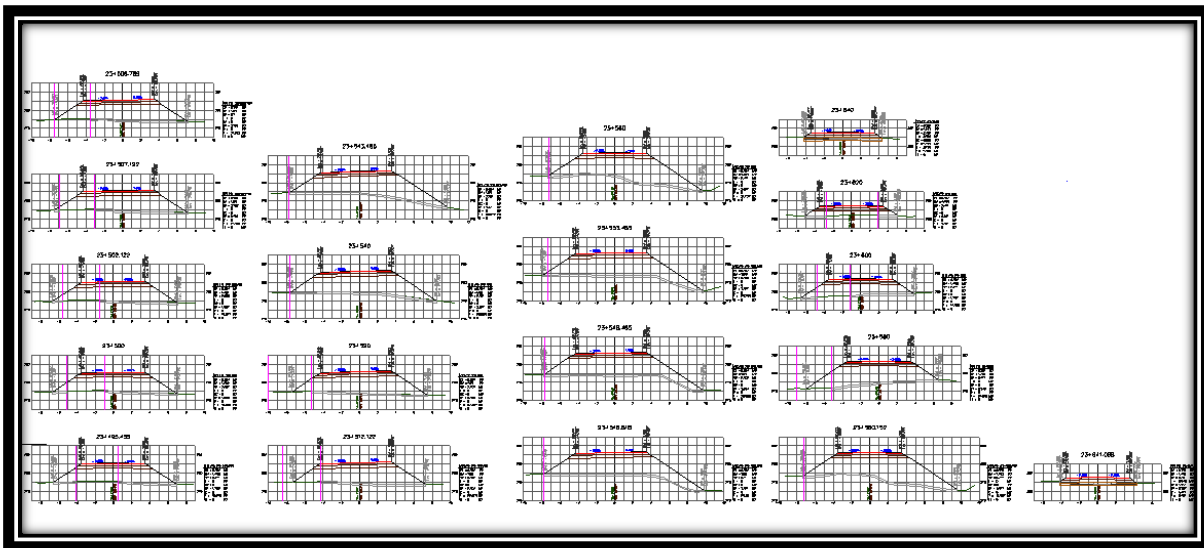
Secciones de construcción del km 23+495.455 al km 23+641.068.
